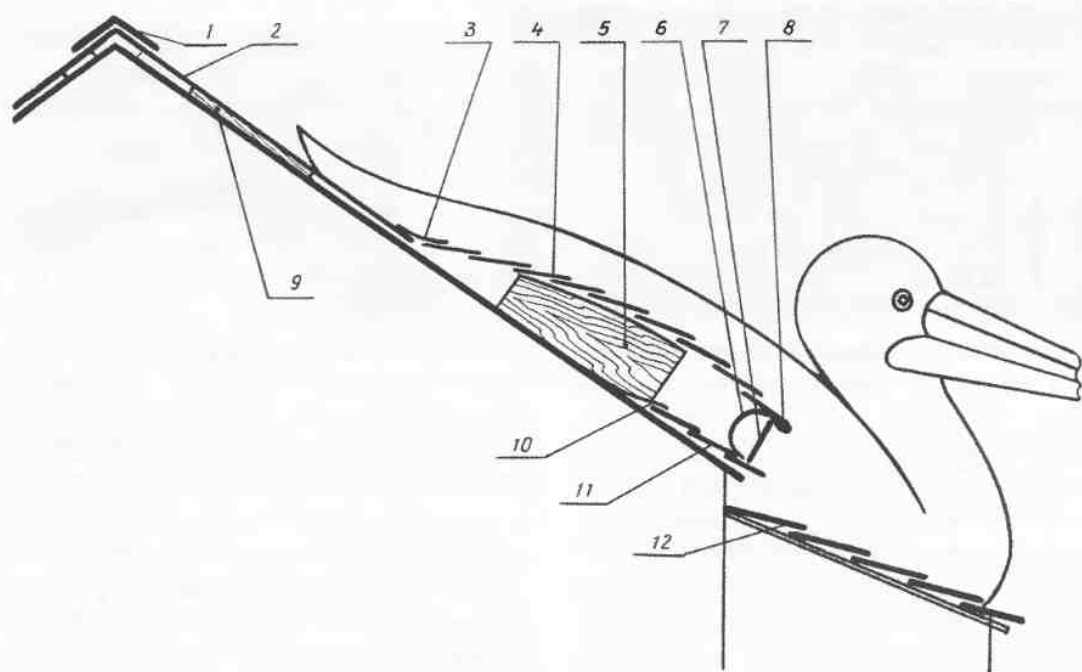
Схема поперечного разреза крыши через крыло пеликана: 1 — охлупень; 2 — доски верхней части крыши; 3 — полоса рубероида, соединяющая верхнюю часть крыши с крылом; 4 — доски крыла; 5 — поперечная доска-подпорка; 6 — заглушка из полосы рубероида; 7 — палка-распорка; 8 — утолщенное переднее «перо» крыла; 9 — прокладки между рубероидным покрытием крыши и дощатым настилом; 10 — нижняя кромка рубероидного покрытия крыши, наложенная на «доски-волны»; 11 — «доски-волны» на кромке крыши; 12 — «доски-волны» на покрытии крыльца
